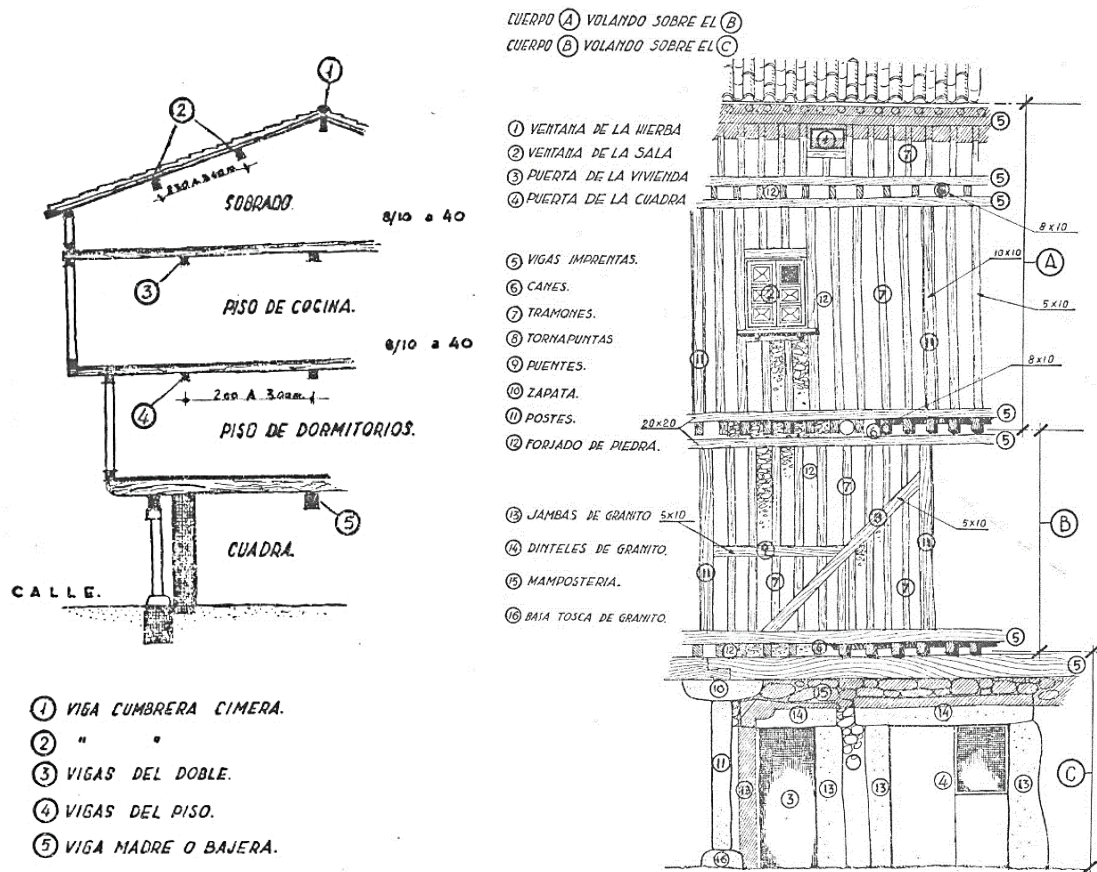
Alzado de fachada y sus vigas. Fuente: González iglesias, 1982.
